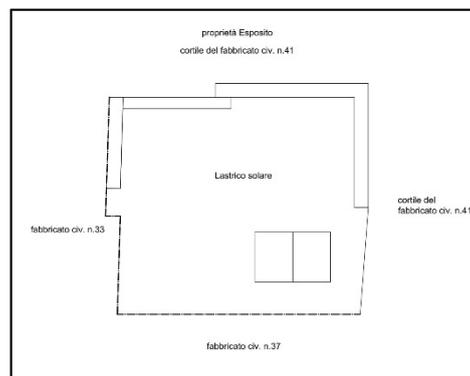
b\_Planimetria di stato attuale del lastrico solare di proprietà esclusiva del locale/laboratorio
